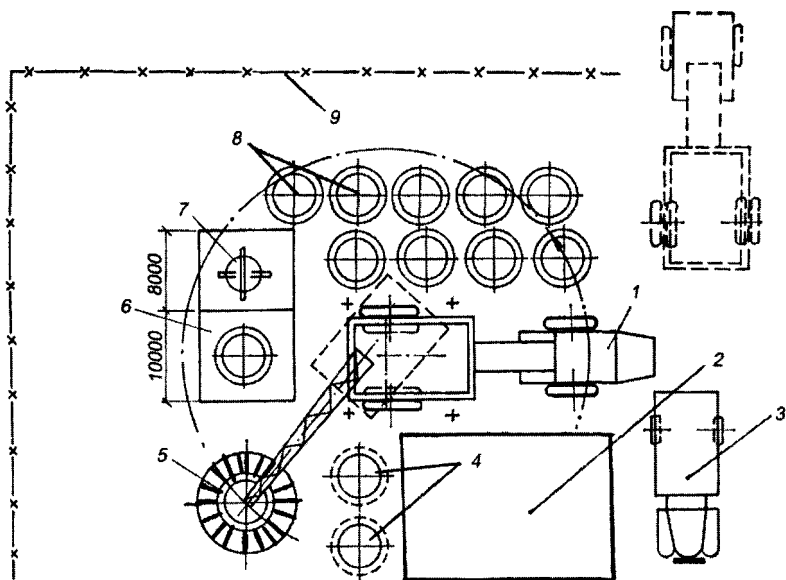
Схема организации монтажной площадки при сооружении металлической дымовой трубы с наружной изоляцией ствола:
